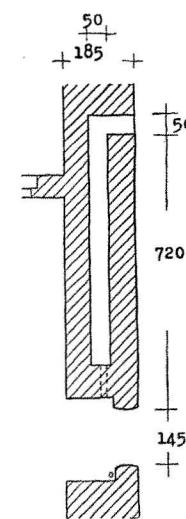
Kasr es-Sağa, Grundriß der Eingangsmauer. Maßstab 1:200.
